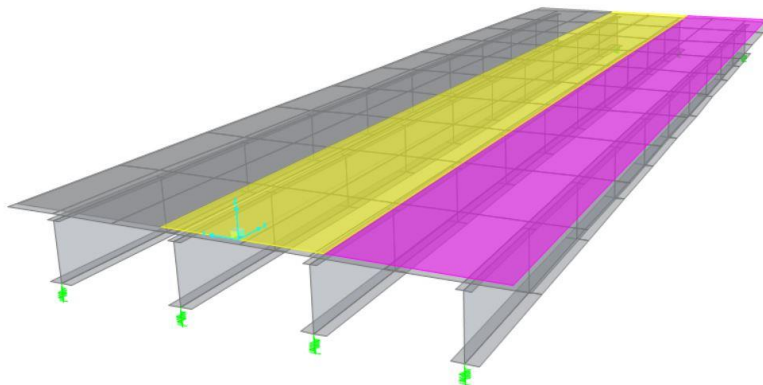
Modèle de pont sur poutres en acier sur CSI Bridge
